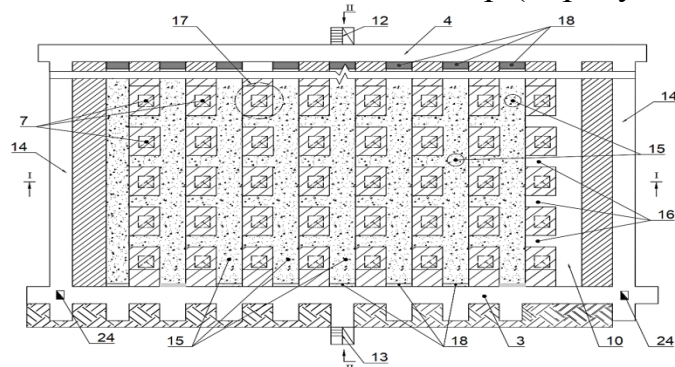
Б – Предлагаемая технология устойчивоопорной железобетонной платформы искусственного днища блоков из бетонно-твердеющей закладки при системе с самообрушением руды
